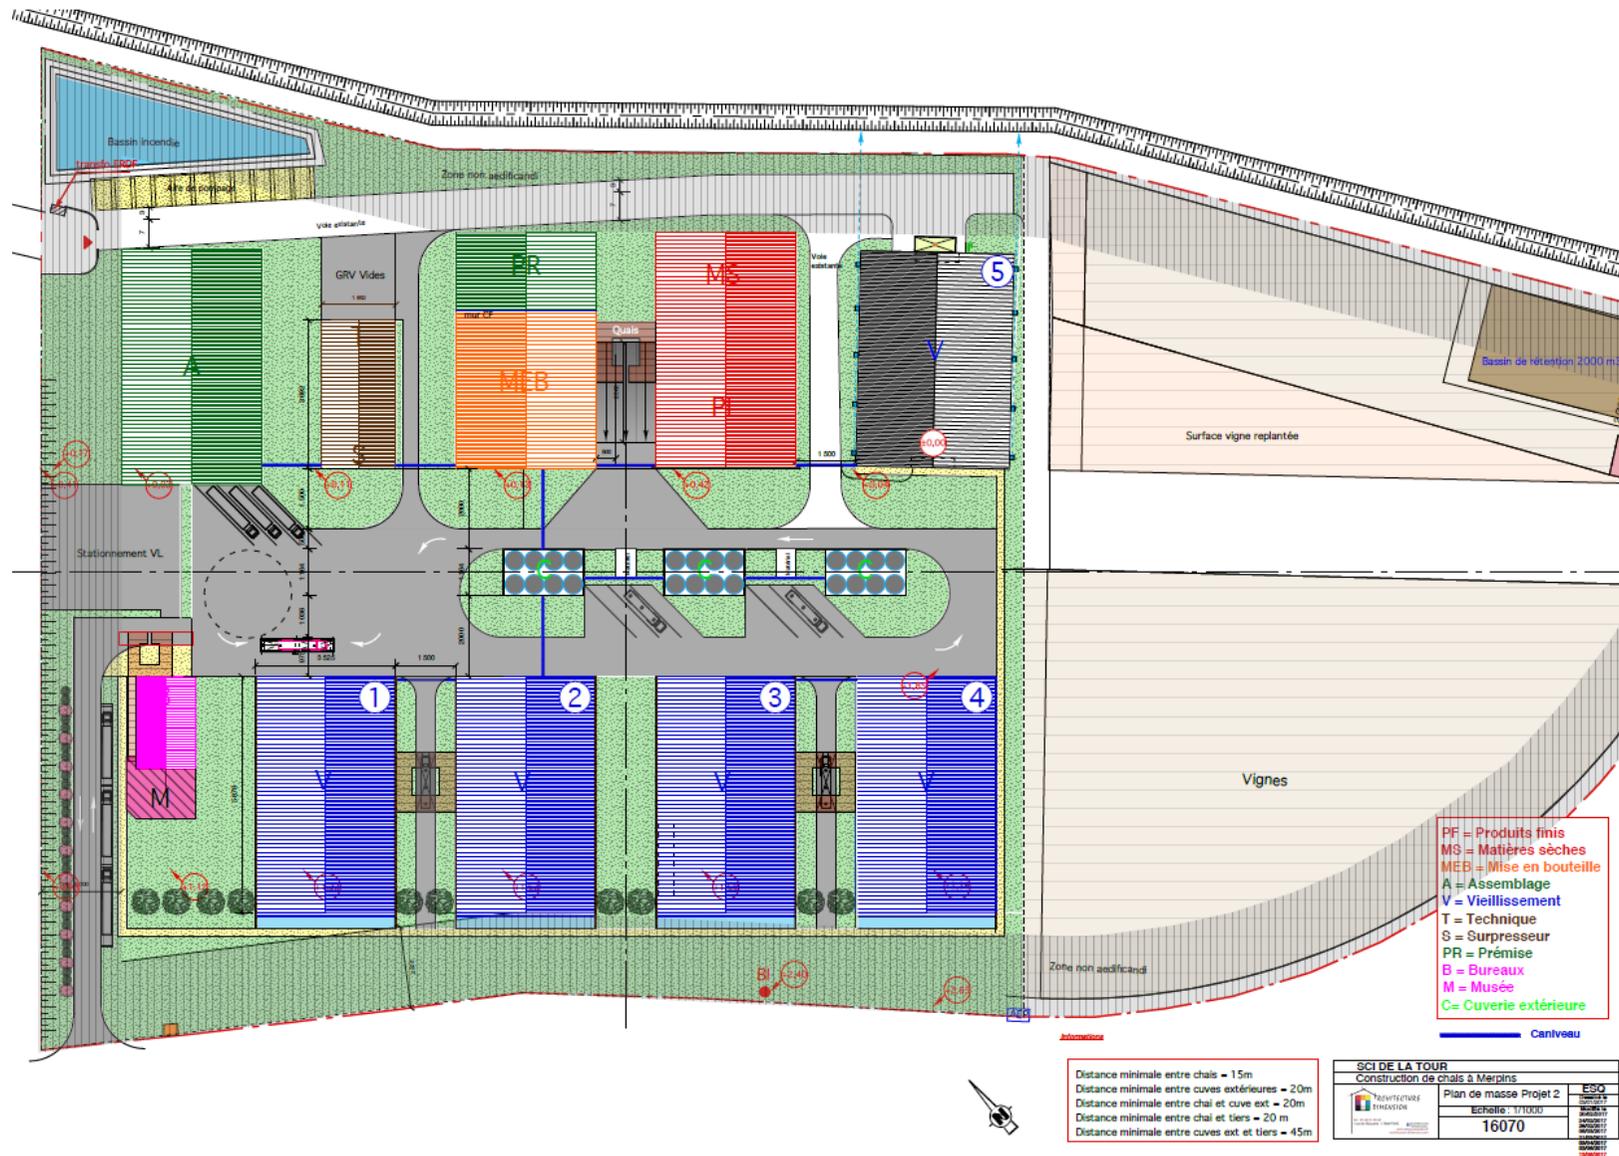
Plan de masse du 12 juin 2017 (source : Architecture Dimension)
